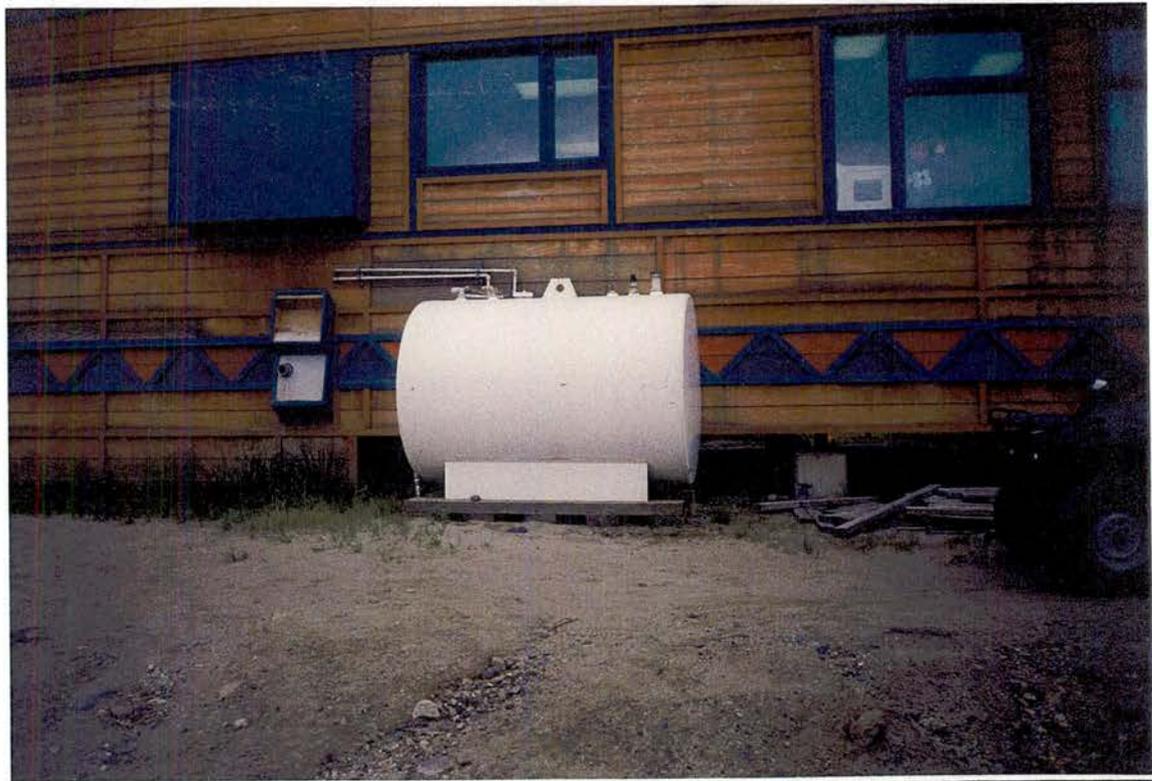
Réservoir de mazout 2 273 litres en face de la garderie.
